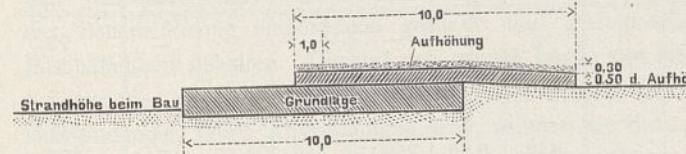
Senkstück ohne Böschungen mit Aufhöhung in Senkstückbau (halb überdeckend).
